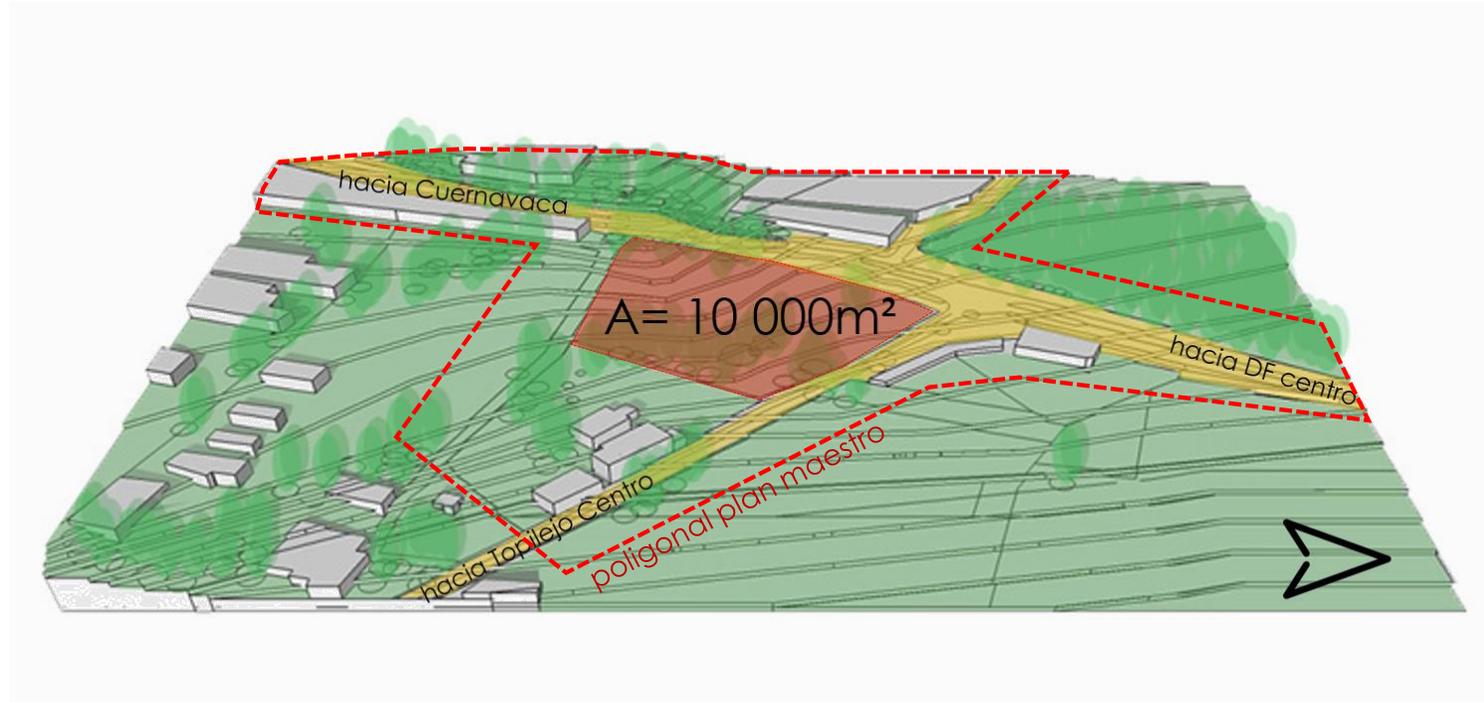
Área del terreno y poligonal del plan maestro
